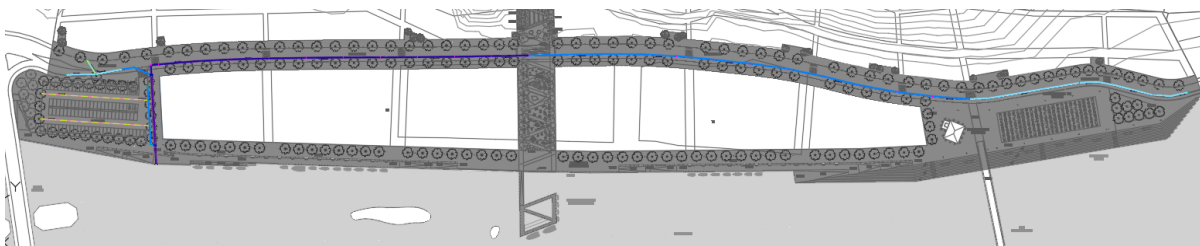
Linjat kryesore të drenazhimit të propozuara në zonën e projektit
